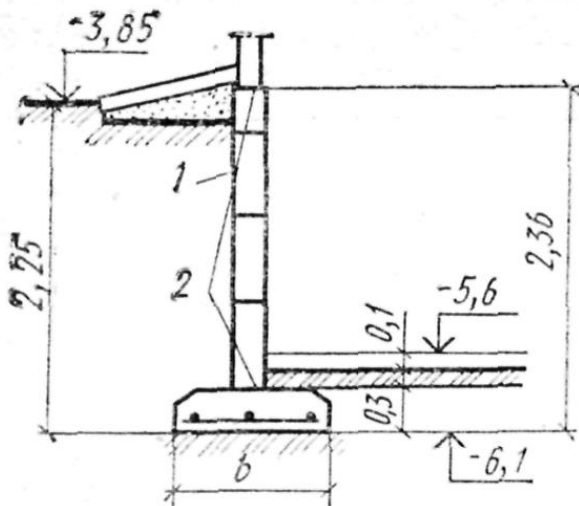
Фундамент зовнішньої стіни в підвальній частині будівлі: 1 – обмазування бітумом; 2 – рулонна гідроізоляція
